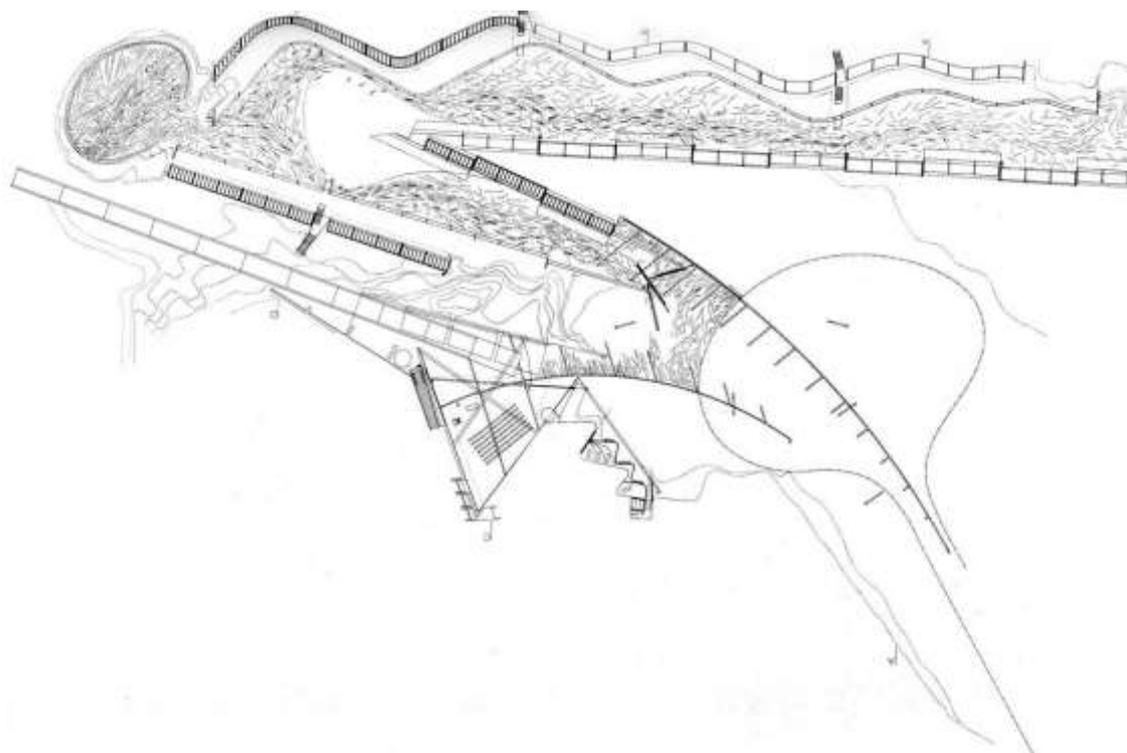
“Plano 2 (ZEMENT+IRI 2), Planta general y perfil del terreno desde el río (escala 1:500).” (Fundació Enric Miralles, 2014)
